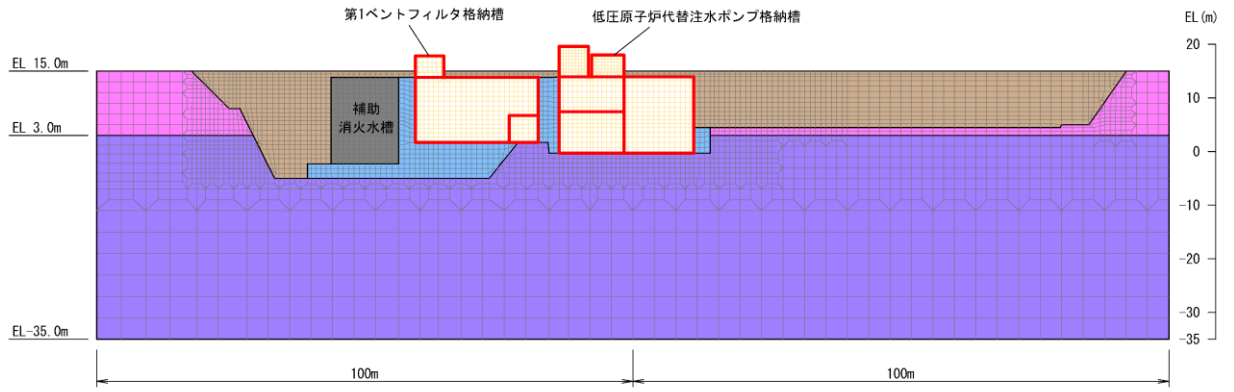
第1ベントフィルタ格納槽 地震応答解析モデル図 (C-C断面)
